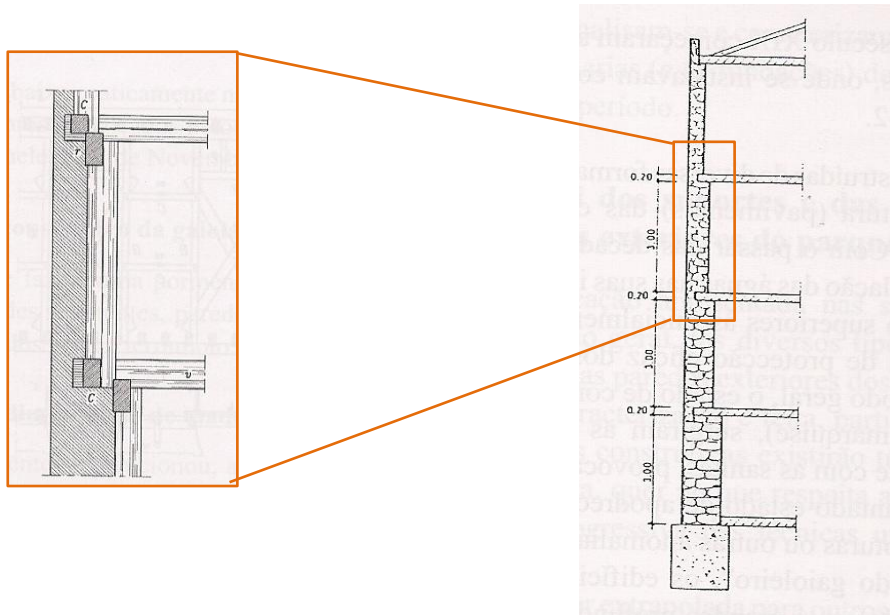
Pormenor construtivo da gaiola - redução de espessura da parede (adaptado de Pinho, 2008).
